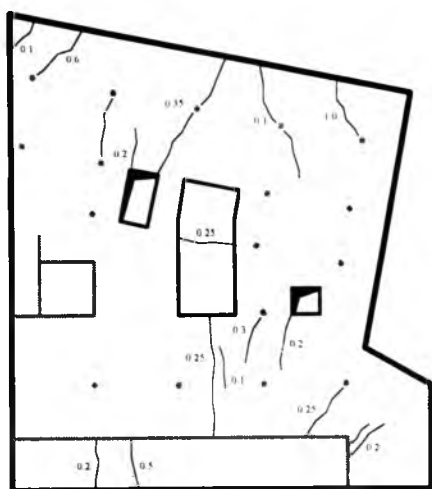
Схема расположения сквозных трещин в перекрытии
